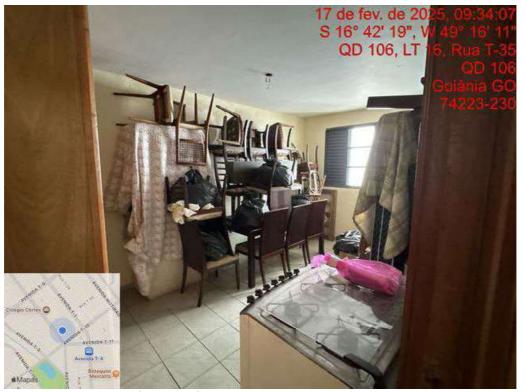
Vista Edícula Suíte 2 - Avenida T-2, Quadra 106 Lote 03/07
